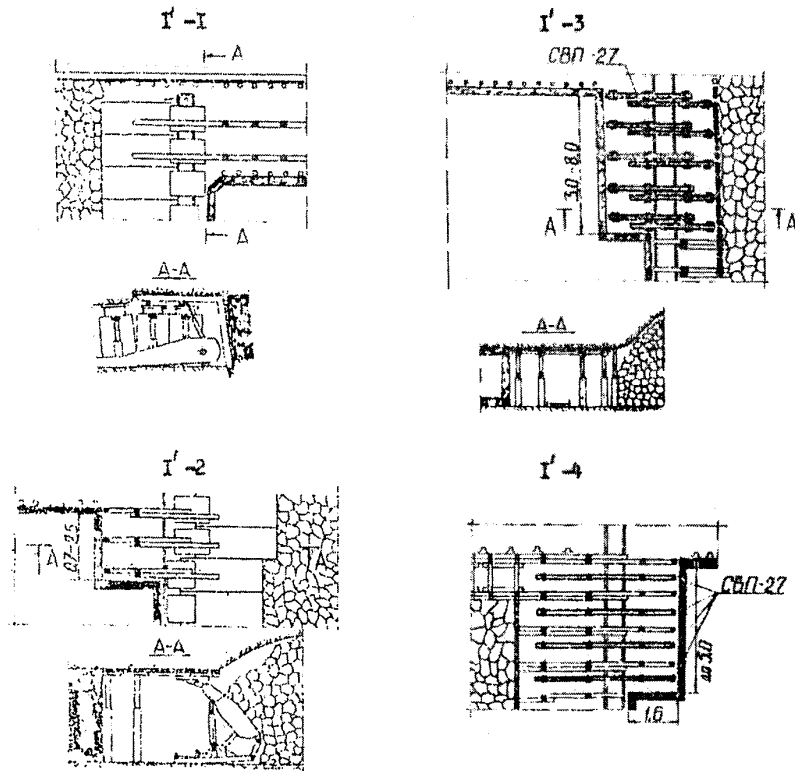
Типовые схемы крепления нити у вентиляционной (рельсовой) выработке
